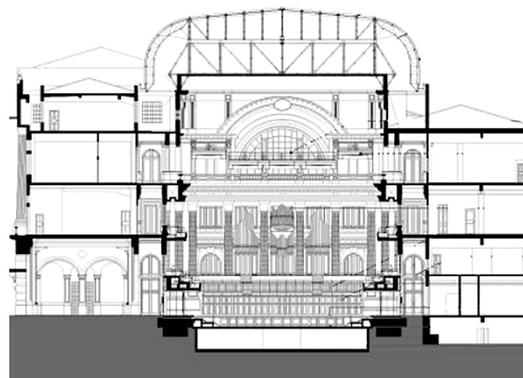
Corte transversal do forro da Sala São Paulo onde se vê a nova cobertura proposta por Nelson Dupré.
